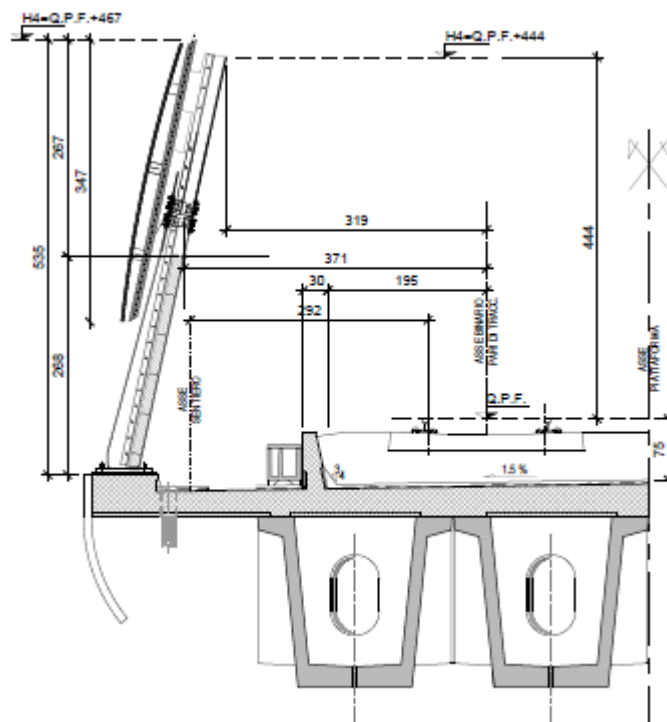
Sezione trasversale dell'impalcato tipo con barriera antirumore
